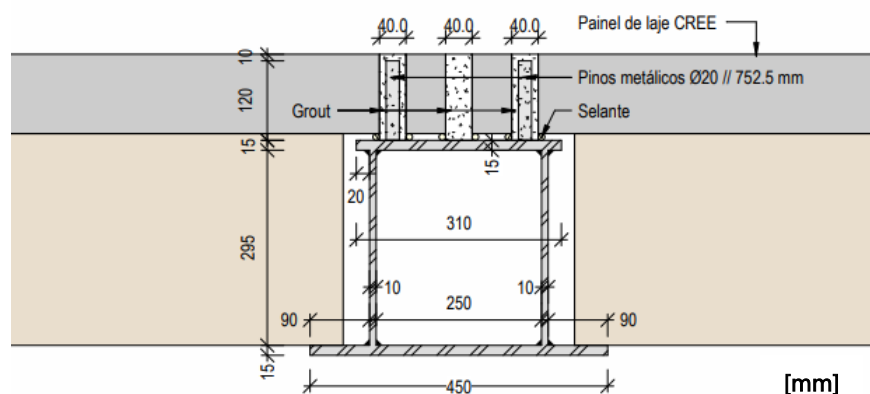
Corte transversal da viga metálica (sem escala)
